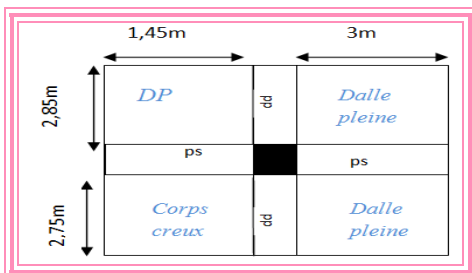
la surface afférente du poteau « C4 » de l'étage 9
